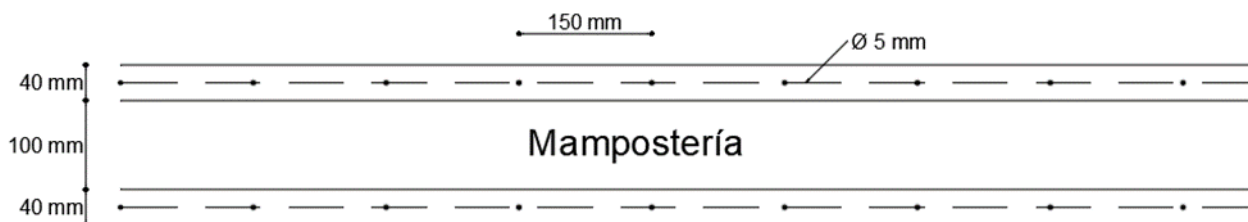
Vista Superior del muro de mampostería de bloque con el Enchape
